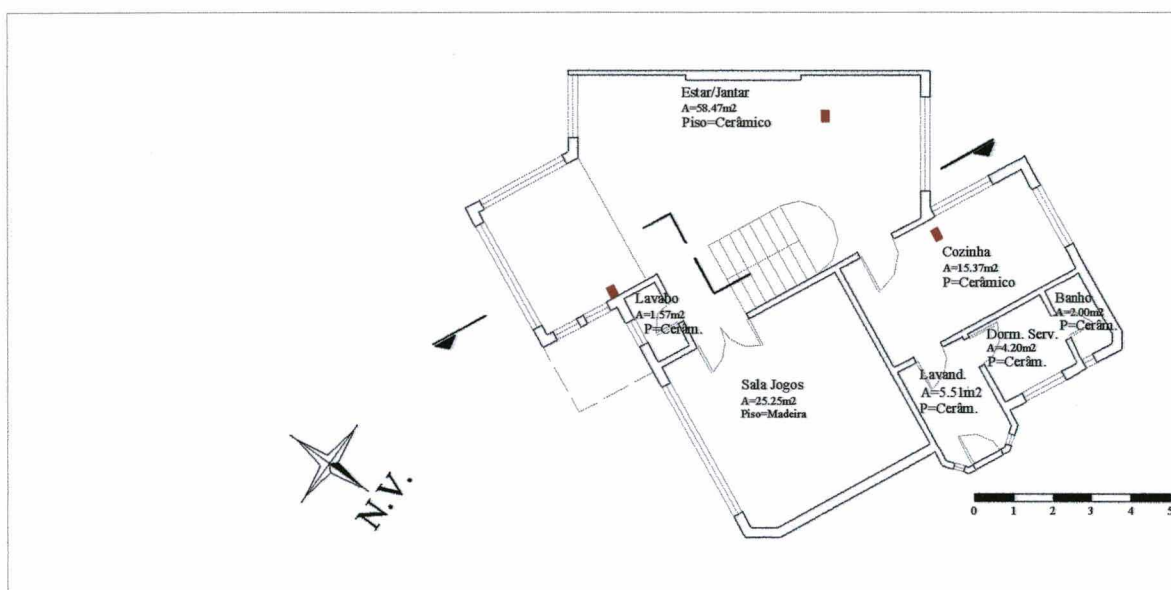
Planta Baixa Pavimento Térreo Residência 1.
